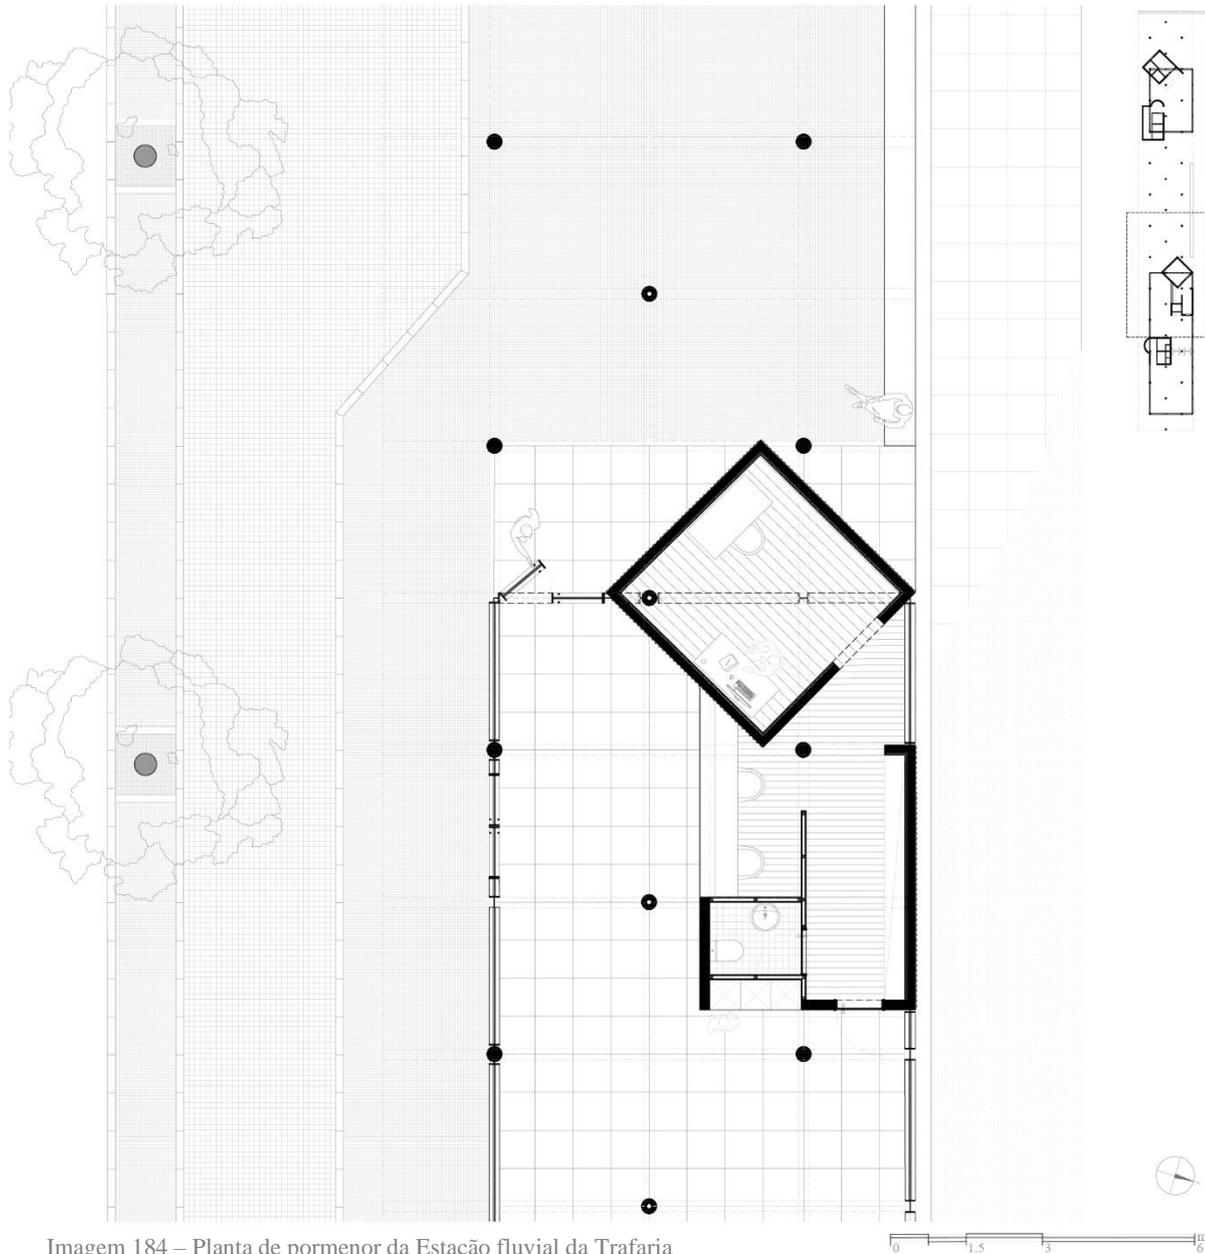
Planta de pormenor da Estação fluvial da Trafaria
